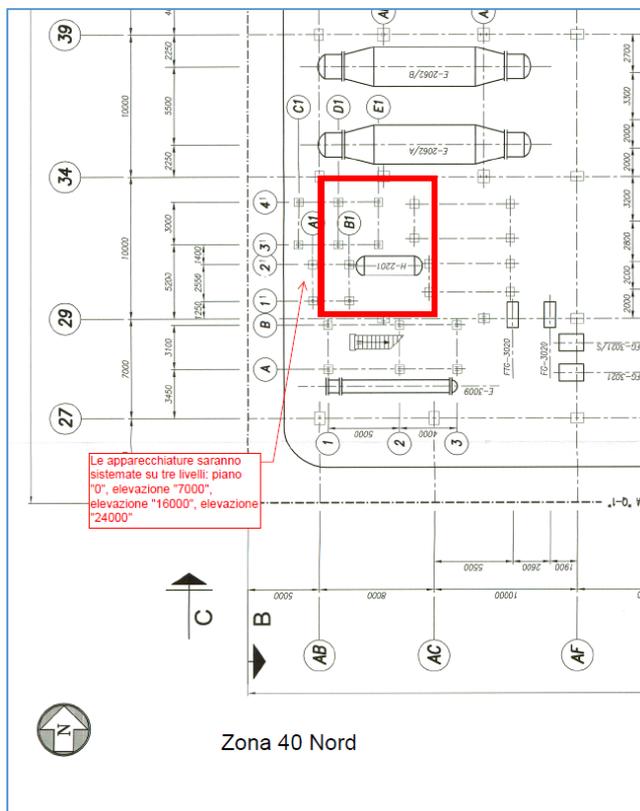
Stralcio planimetrico di posizionamento del nuovo impianto di stripping acque reflue
